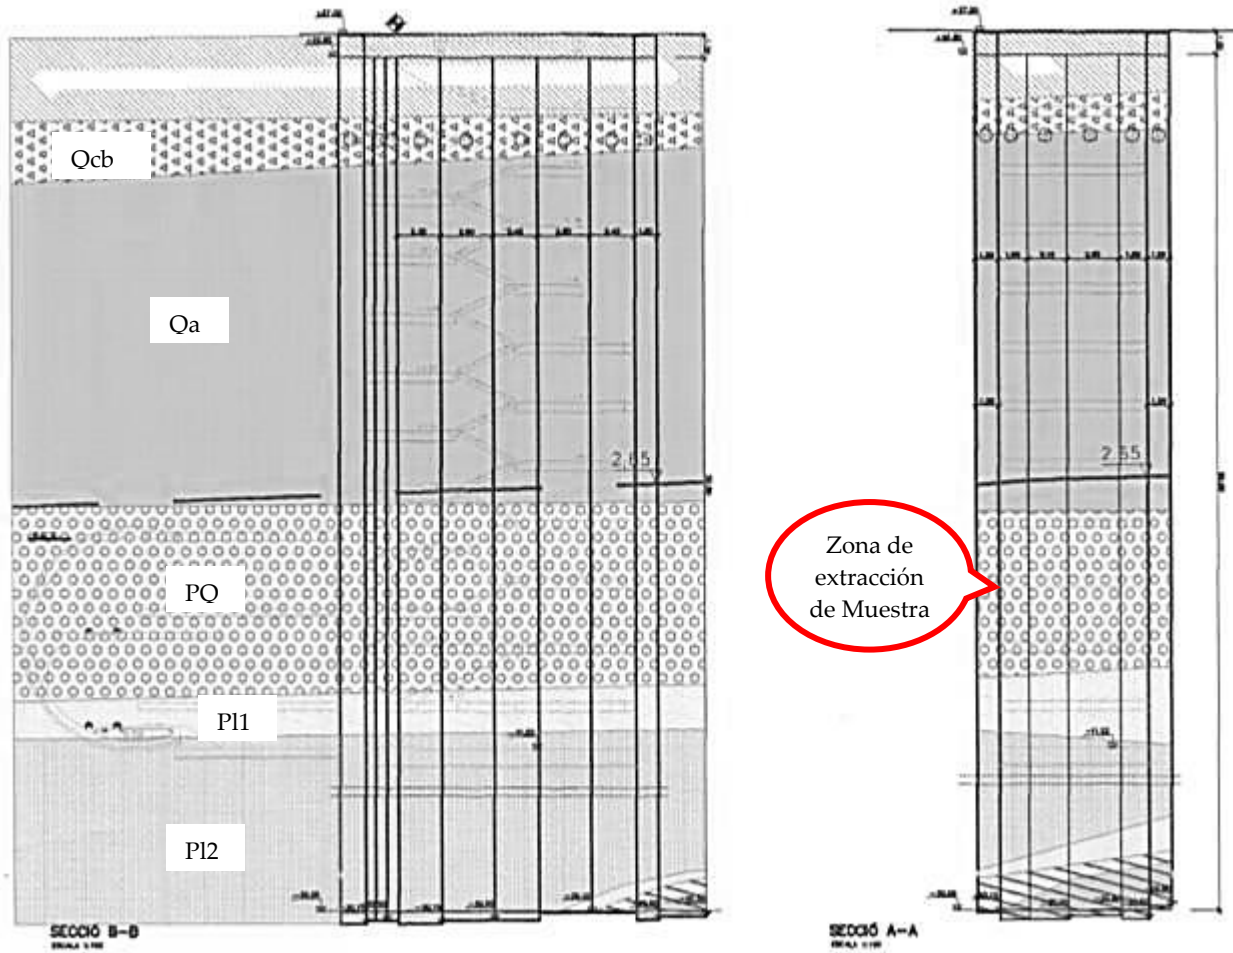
Sección y perfil geotécnico Galería la Salida de Emergencia Felipe II. Proyecto Constructivo Tramo III
